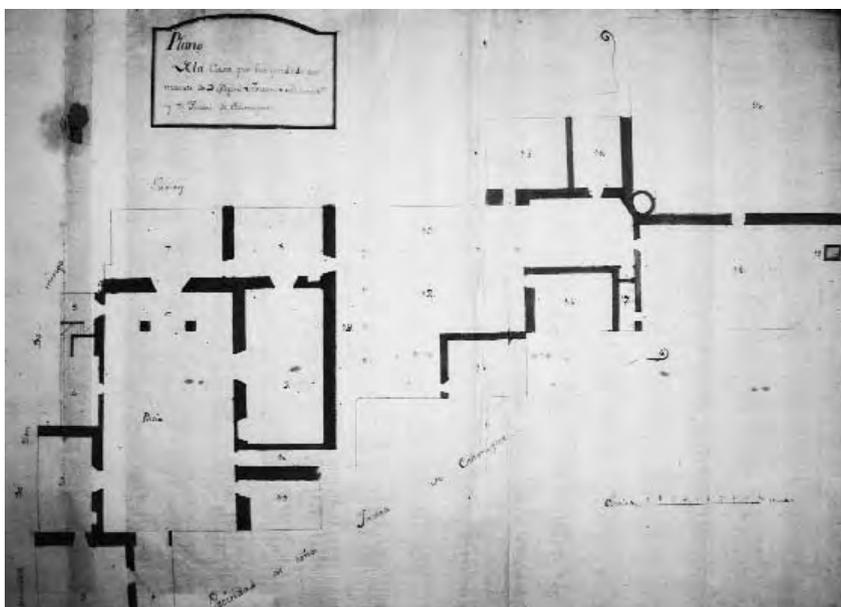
Planta general de la vivienda de la familia Fernández (AHC)
